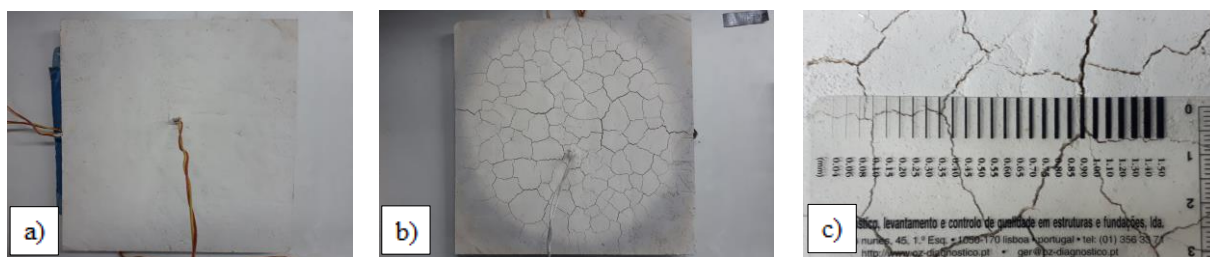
Provete tipo: a) Provete antes do ensaio; b) Provete após o ensaio; c) Fissuração do provete após o ensaio.
